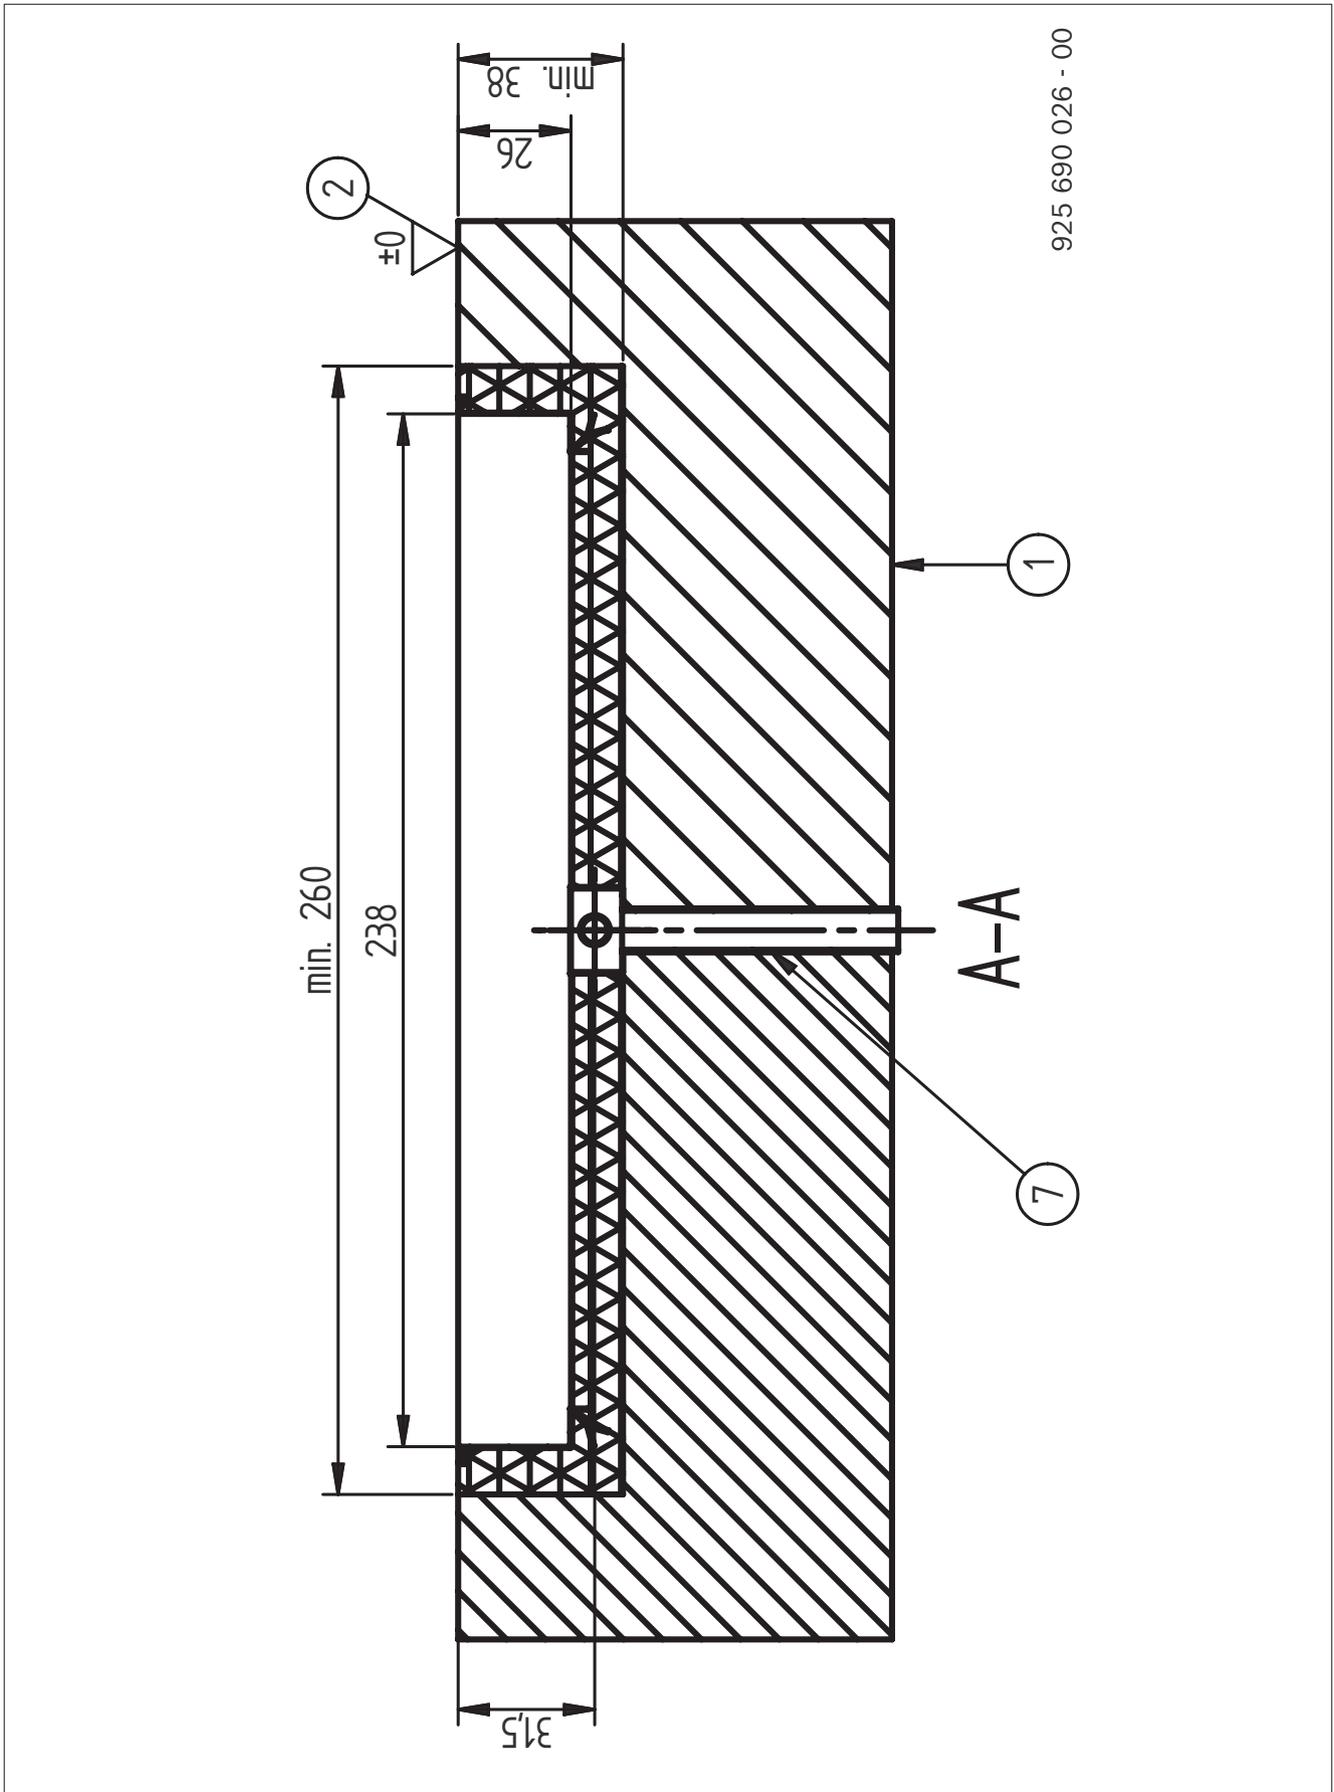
Grubenplan BD 6xx mit Einbauwanne - Schnitt A-A
